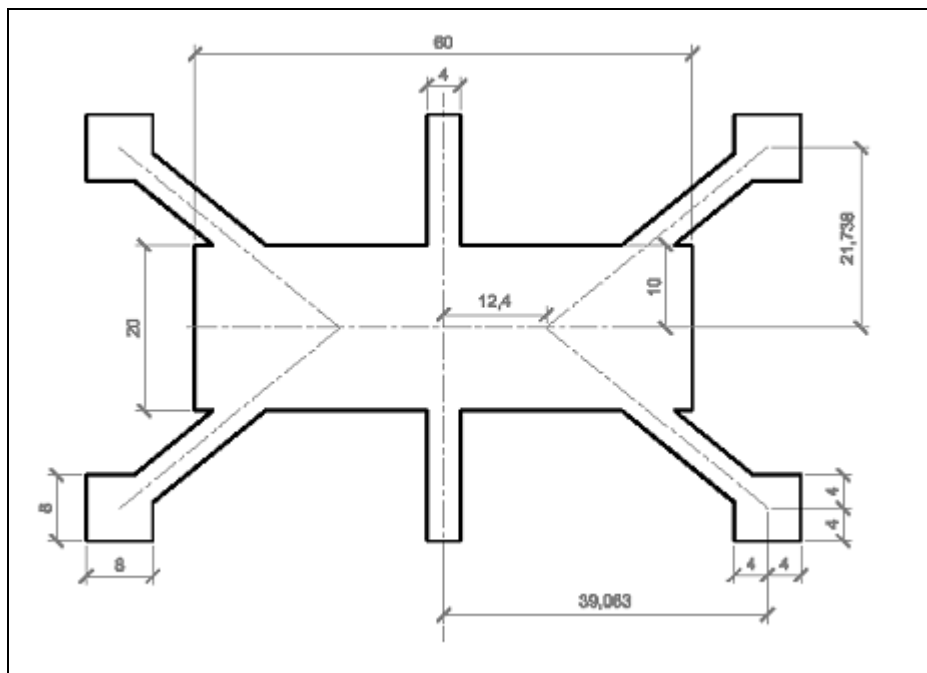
Esquema exemplificado de supressão de vegetação em praças de torres estaiadas (dimensões em metros).
